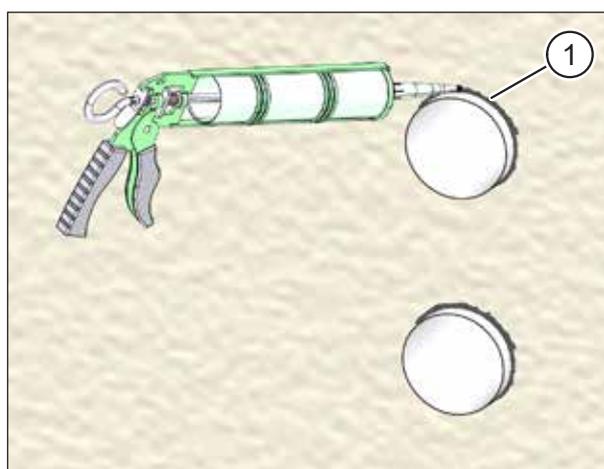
Étanchéifier les tuyaux d'aération sur le mur extérieur
